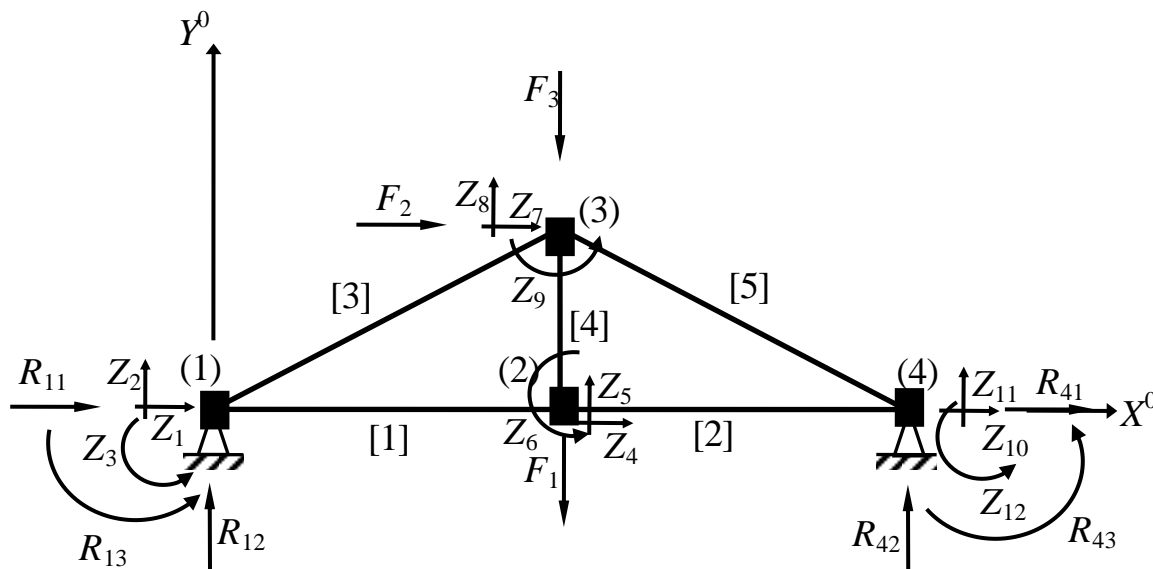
Расчётная схема фермы с жёстким соединением узлов и жёстким опиранием
